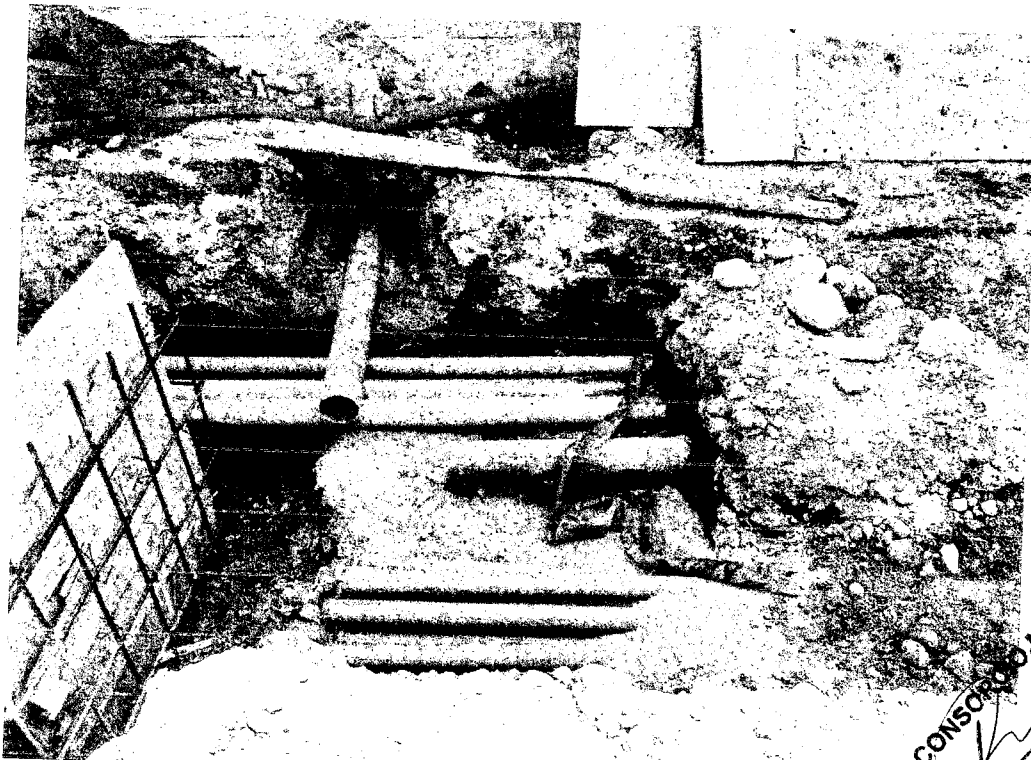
Colocación de tuberías eléctricas y buzones de concreto
